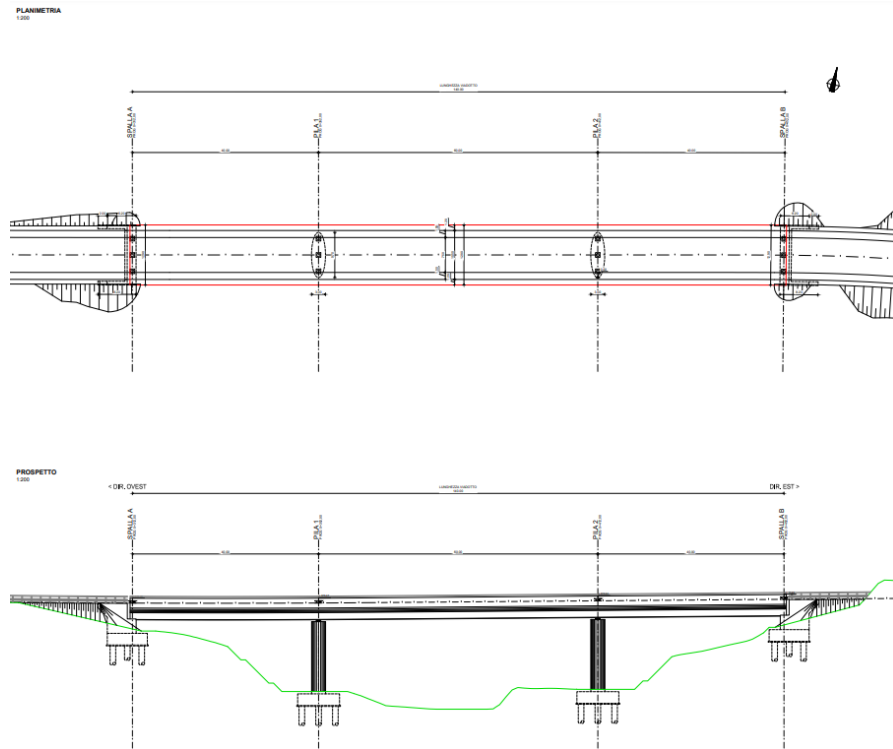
Planimetria e prospetto viadotto (rif. Tav. T01VI01STRPF01)
